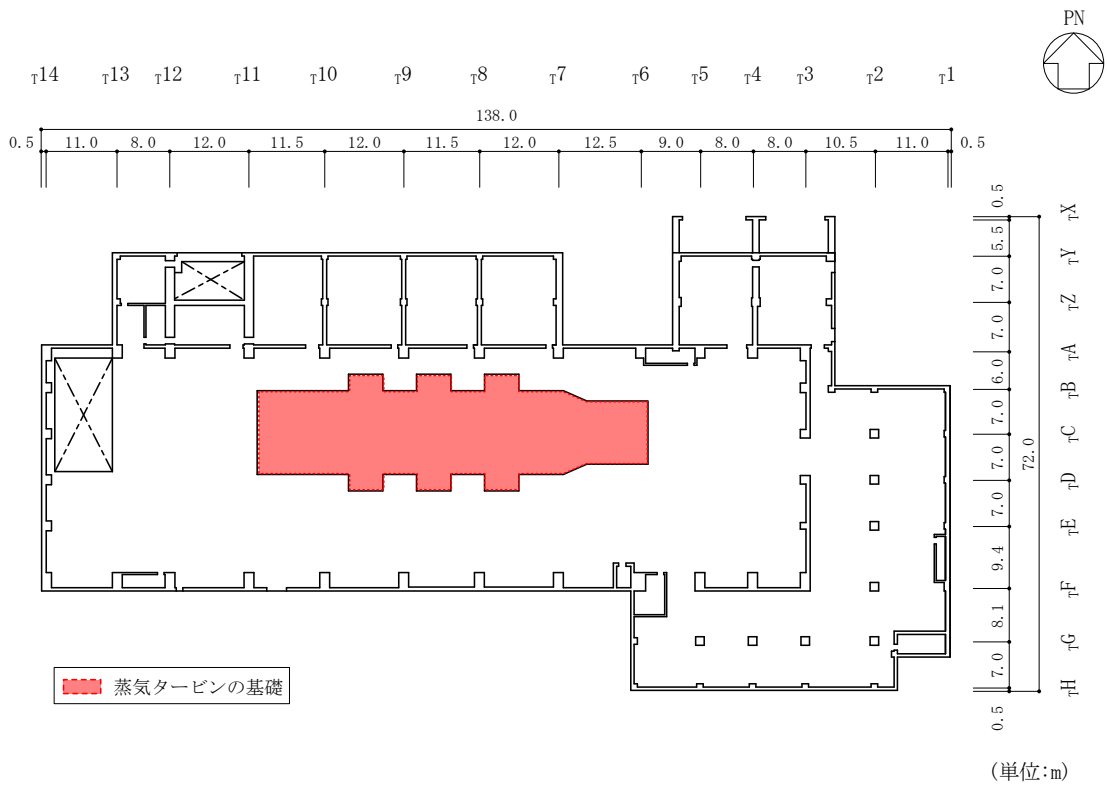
(2) タービン建物の概略平面図 (EL 20.6m)
